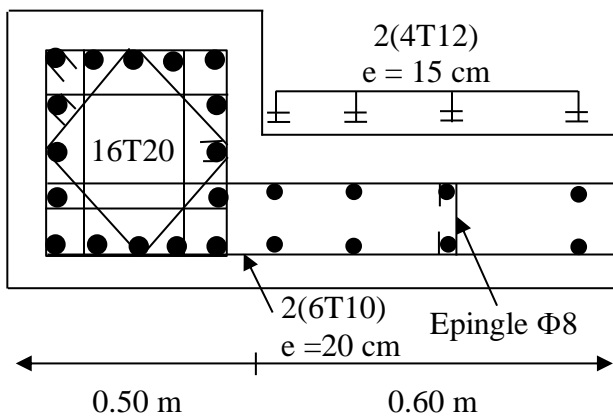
Schéma de ferrailage du voile rectangulaire avec deux poteaux.
